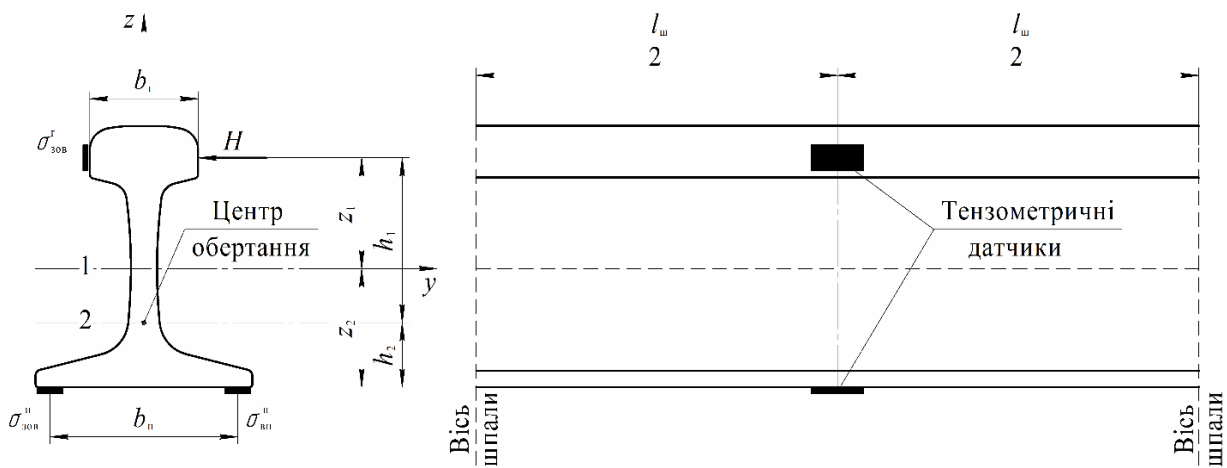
Схема вимірювання напружень в кромках підшви і зовнішній кромці головки рейки:
